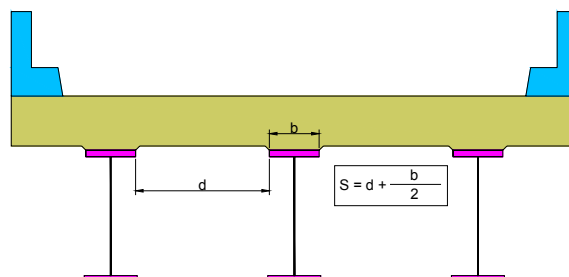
Longitud efectiva para losas apoyadas sobre vigas
